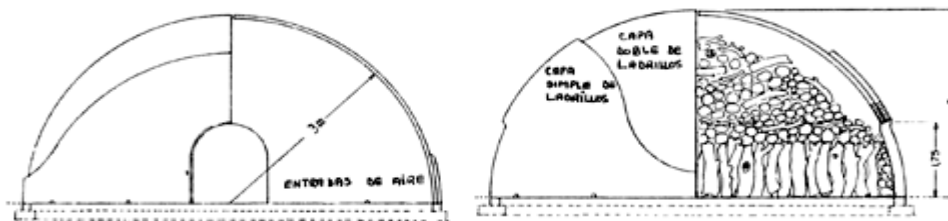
El horno es semiesférico, con dos puertas opuestas para facilitar la carga y descarga y para ventilar. El caparazón es mayormente de un solo estrato de ladrillos con una doble fila alrededor de cada puerta.
